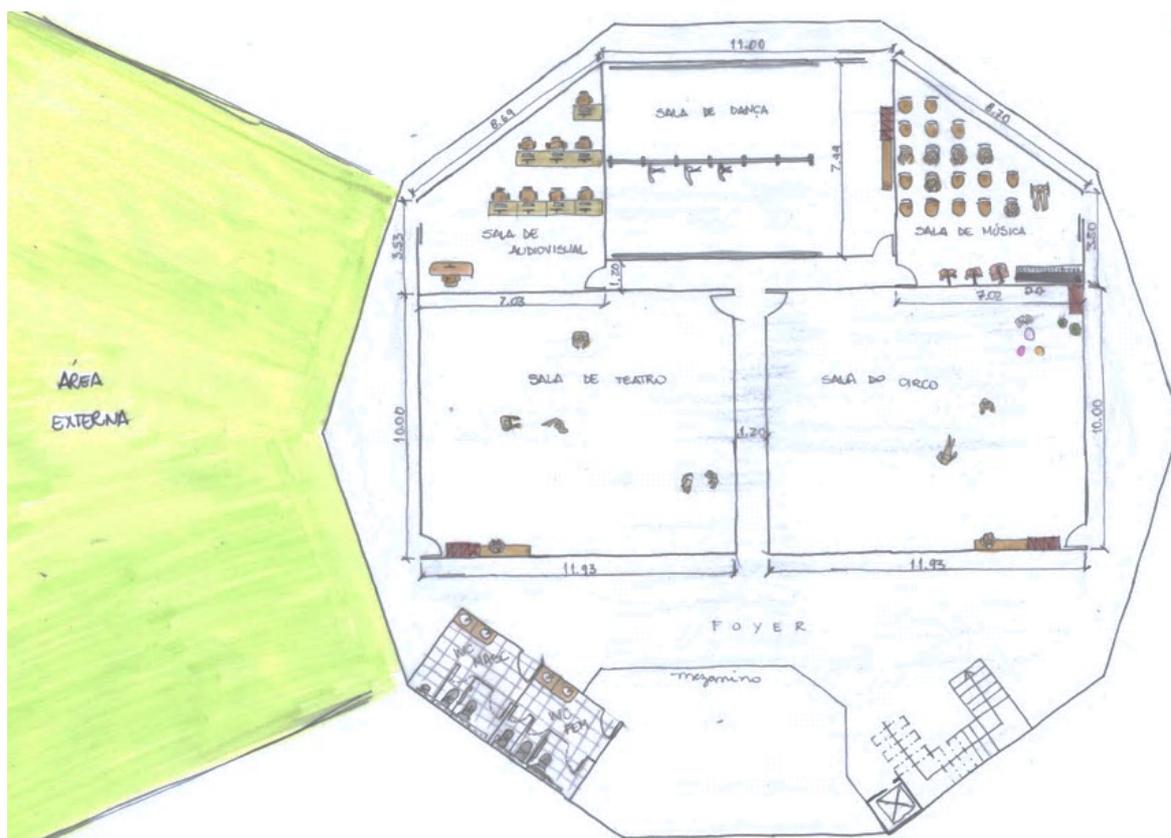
Planta de Layout em croqui do primeiro pavimento
